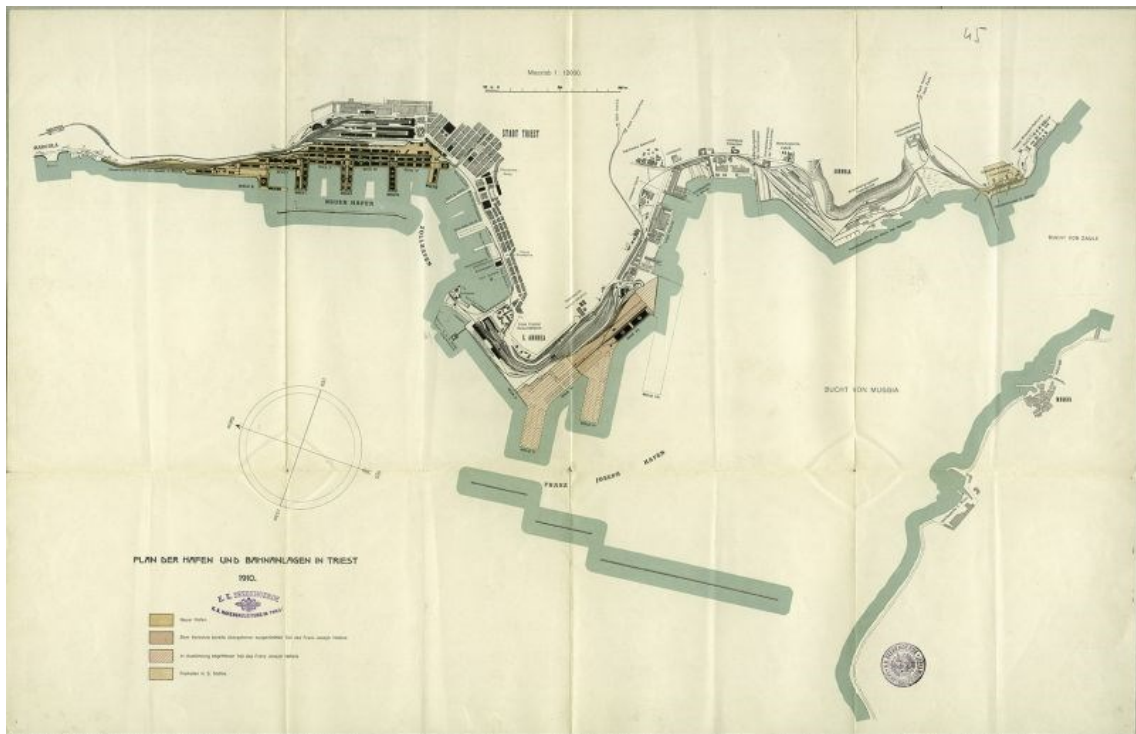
K.K. Seebehörde – K.K. Hafenbauleitung in Triest. Plan der Hafen und Bahnanlagen in Triest, 1910, aus dem Staatsarchiv in Triest
